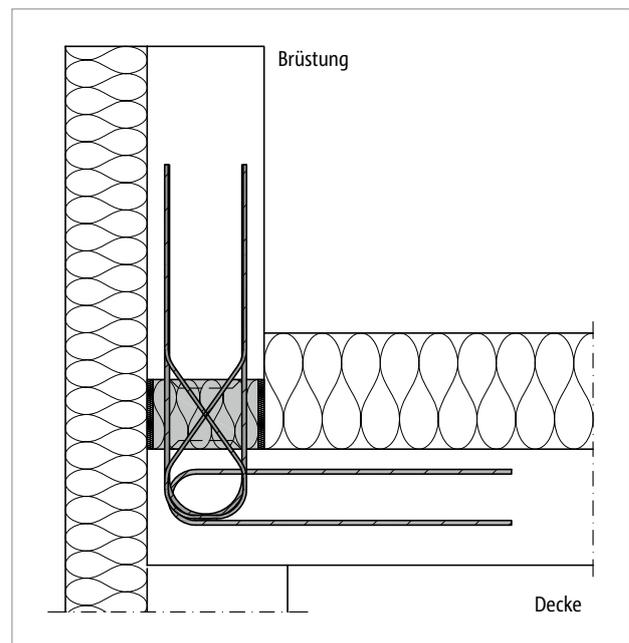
Schöck Isokorb® XT Typ A: Anschluss einer Brüstung (XT Typ A-MM2)
